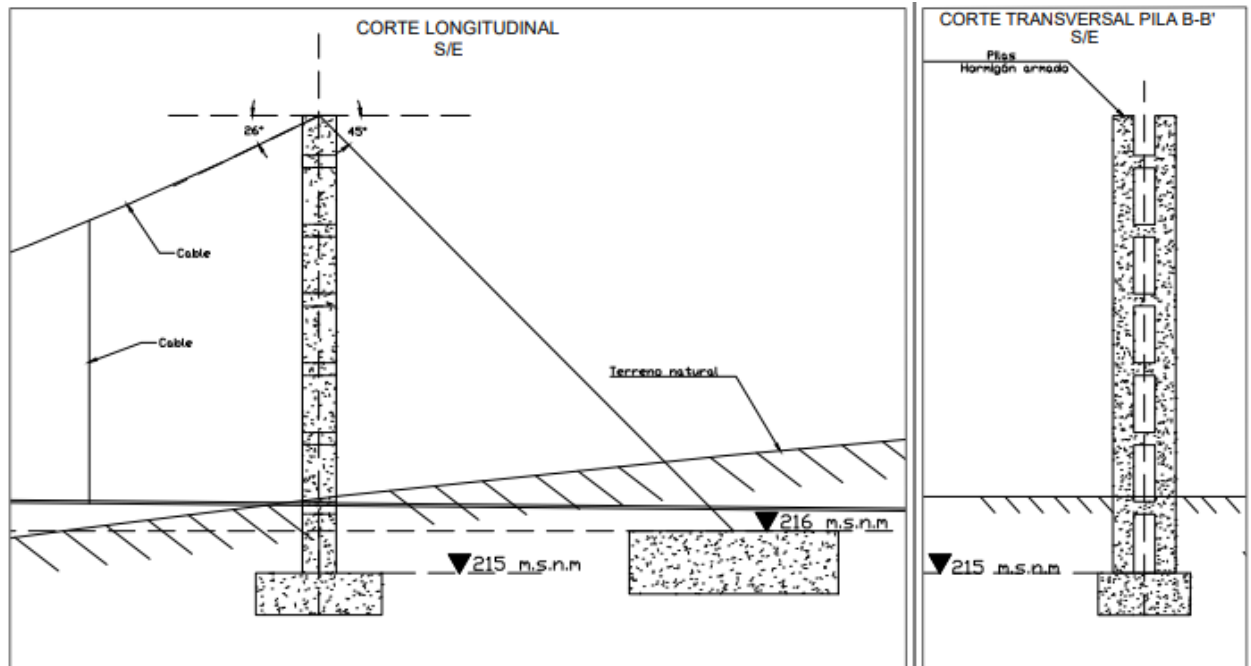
Vista longitudinal y lateral para pila B-B´.
